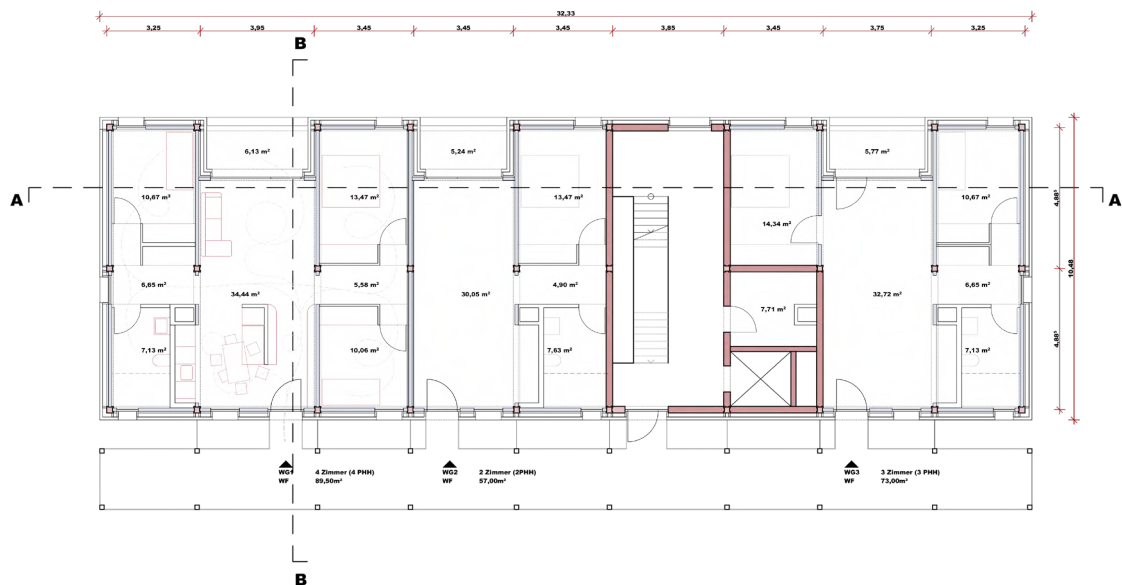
Regelgeschoss Grundrisse Referenzgebäude C
